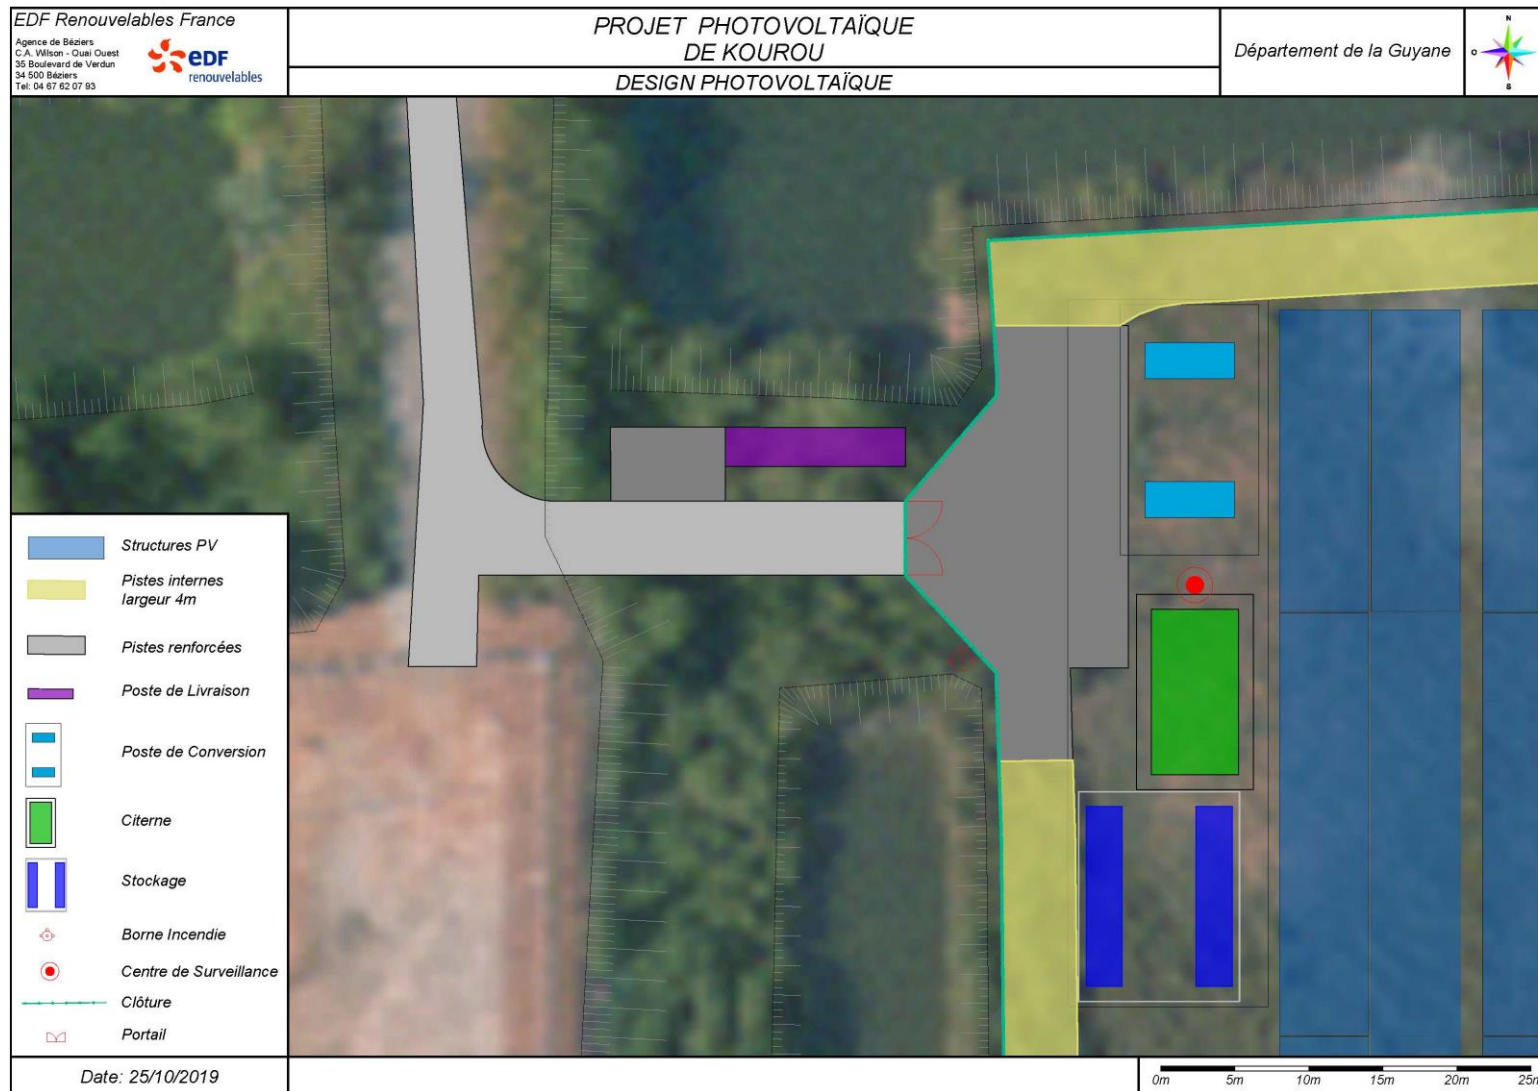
Plan du projet : zoom sur l'entrée de la centrale – Vue aérienne
